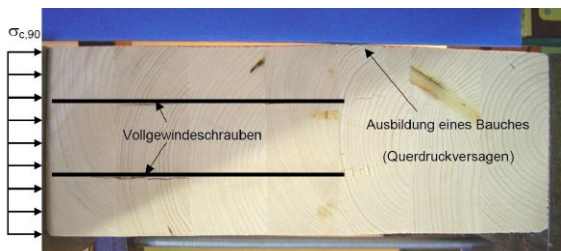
Versagensmechanismus: Querdruckversagen an der Stelle der Schraubenspitze nach [5]
